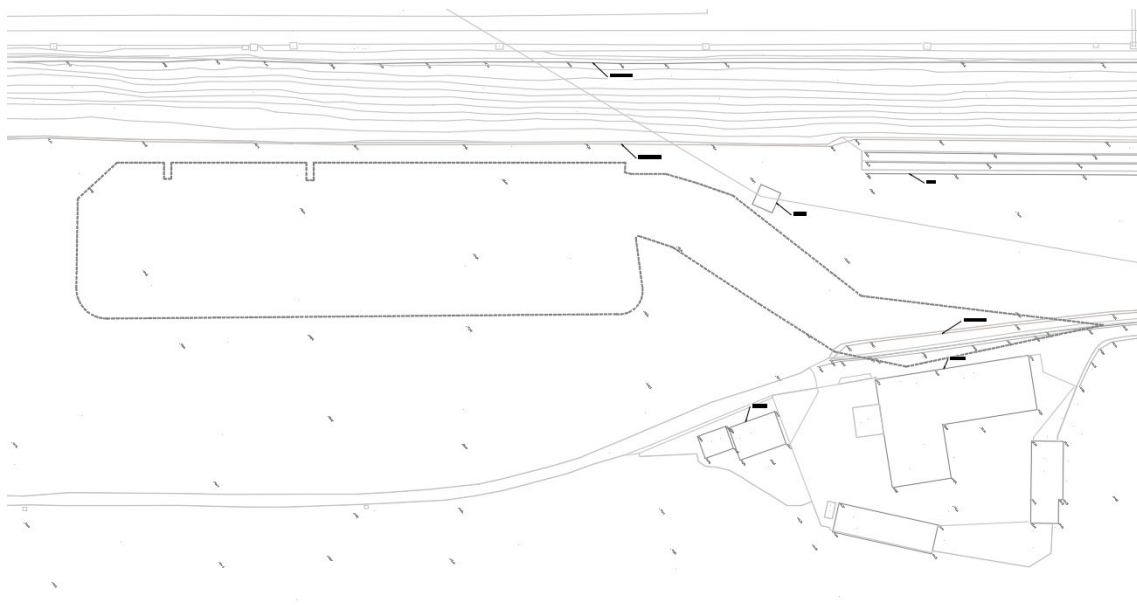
Estratto planimetrico dello stato di fatto – Individuazione dell'area oggetto di intervento con polilinea nera tratteggiata.
